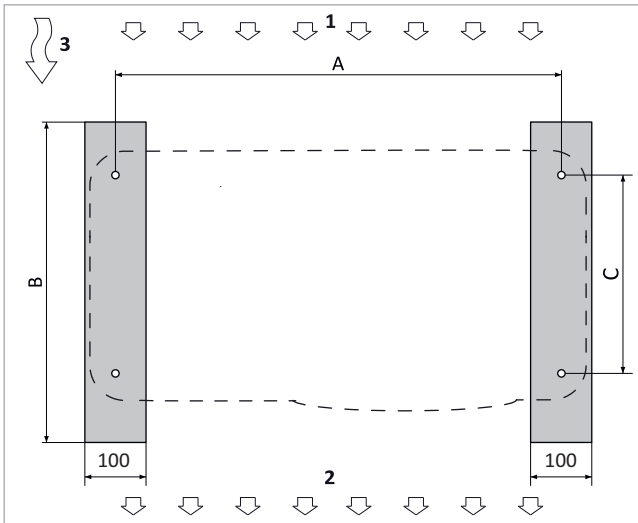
Fondamenta per consolle verticale SolvisLea (vista dall'alto)
